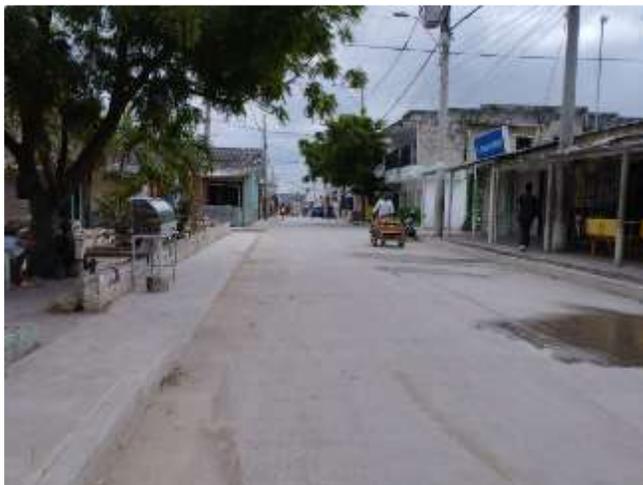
BARRIO BARLOVENTO CARRERA 46C ENTRE CALLES 9AY 9- 35.00 METROS LÍNEAS DE ANDEN Y BORDILLO - módulo 9.
